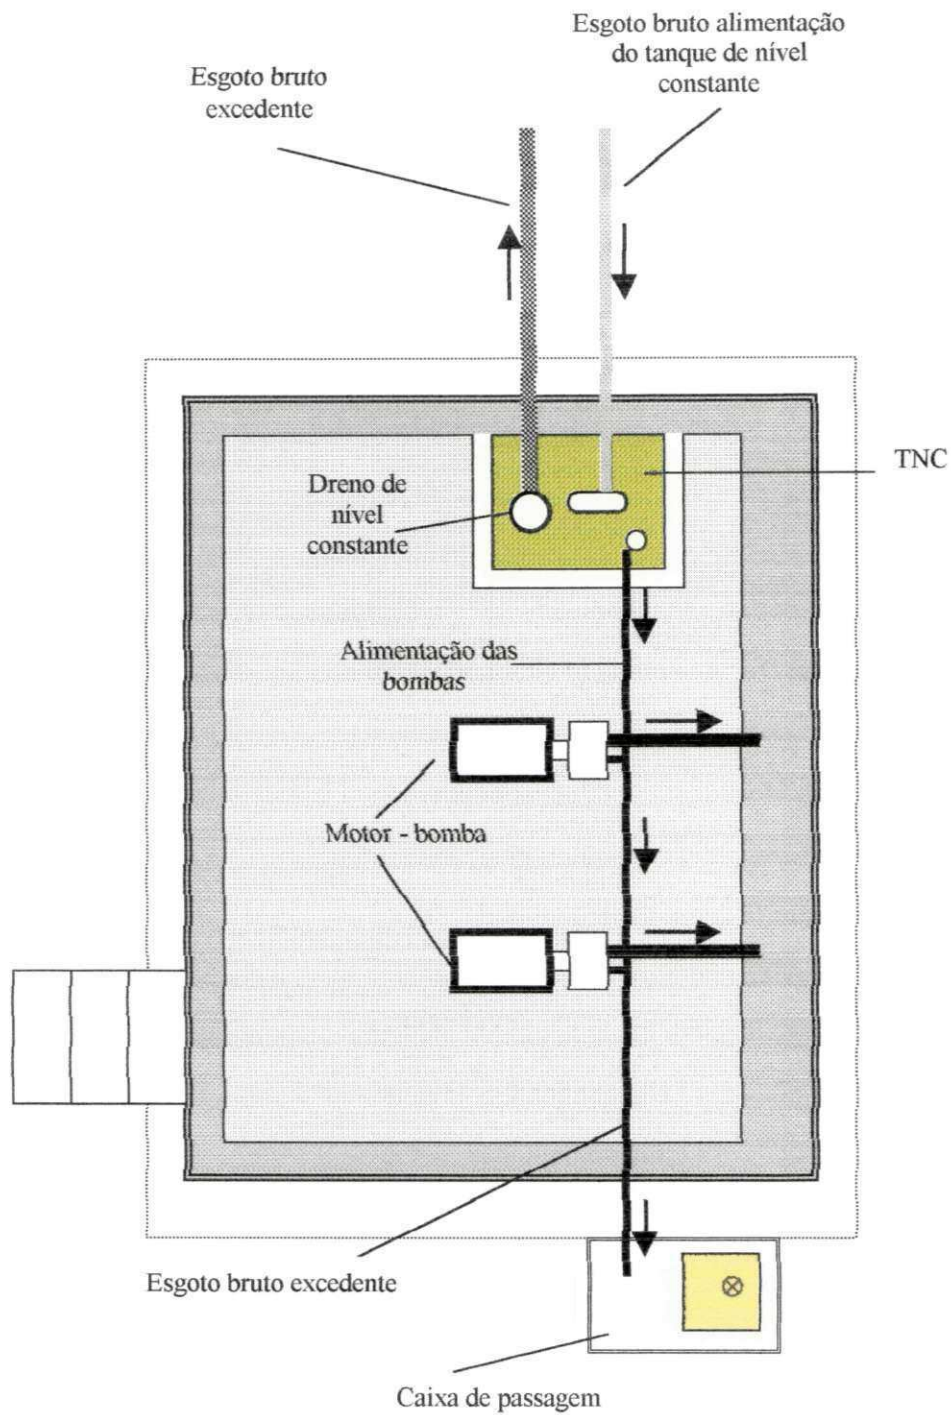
Planta baixa da casa de bombas localizada na EXTRABES – Campina Grande - PB.
